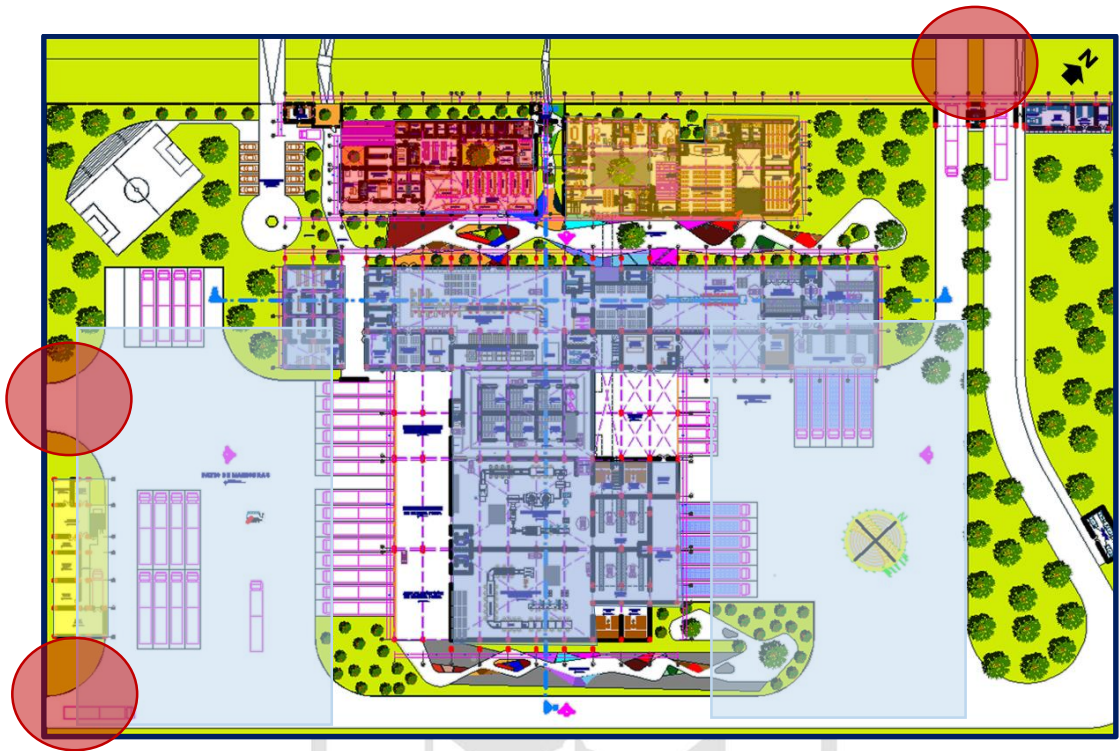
Primera imagen de la arquitectura Fuente: Propia
